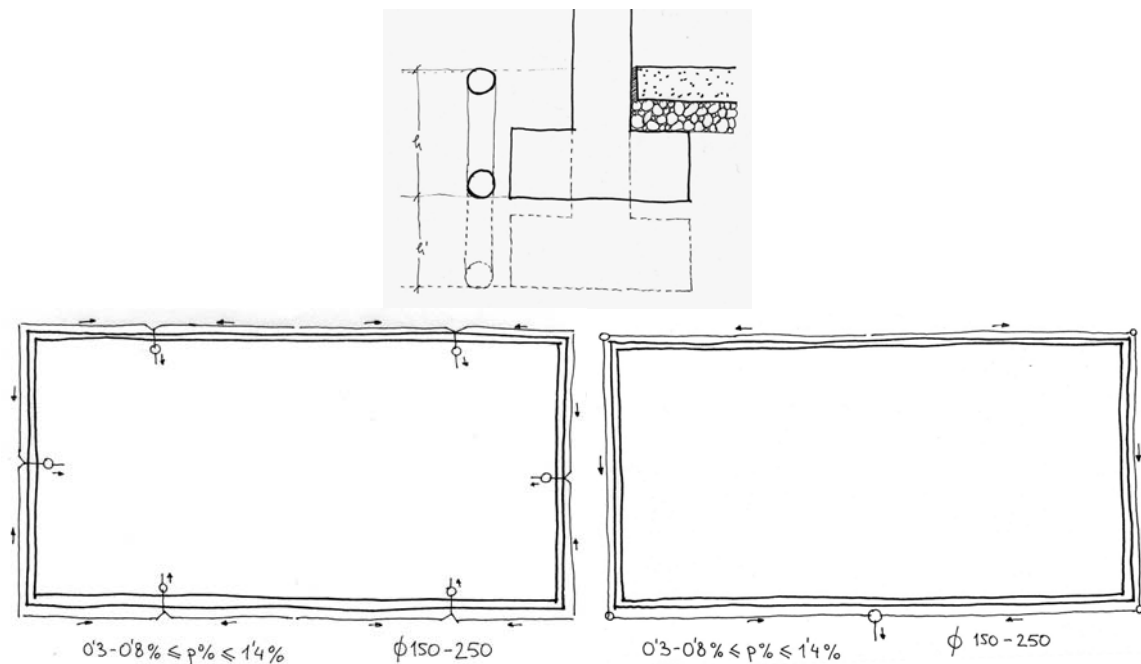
Trazado de una red horizontal de drenaje con cota superior 20 cm por debajo de la solera, rango de pendientes y cota inferior sin sobrepasar la cimentación. Solución con escalonamiento de la cimentación y solución con múltiples conexiones a la red interior enterrada. Fuente: Elaboración propia.
